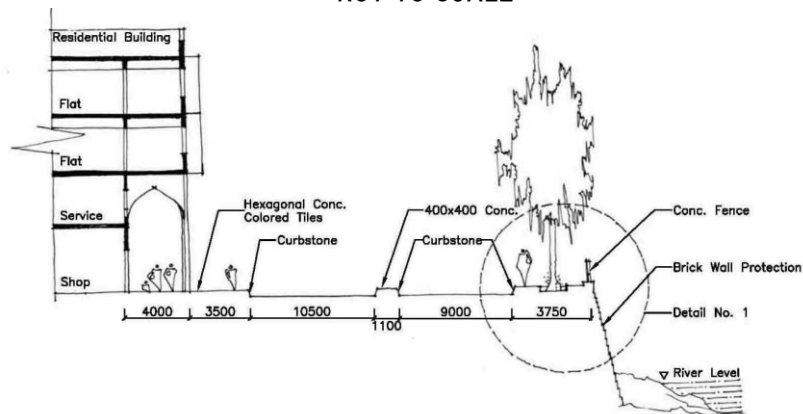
街路横断面图-2 (B-B ~ D-D 断面)
